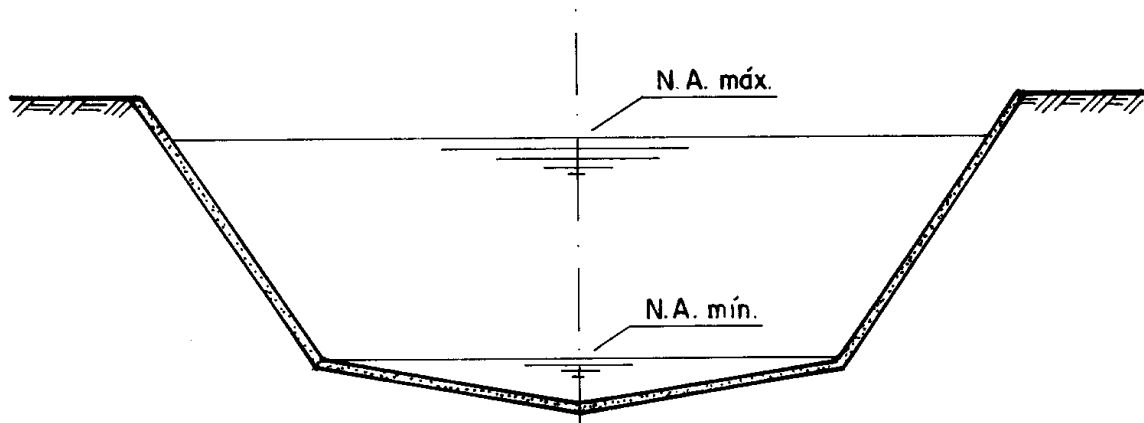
Canal em concreto - Seção trapezoidal mista
